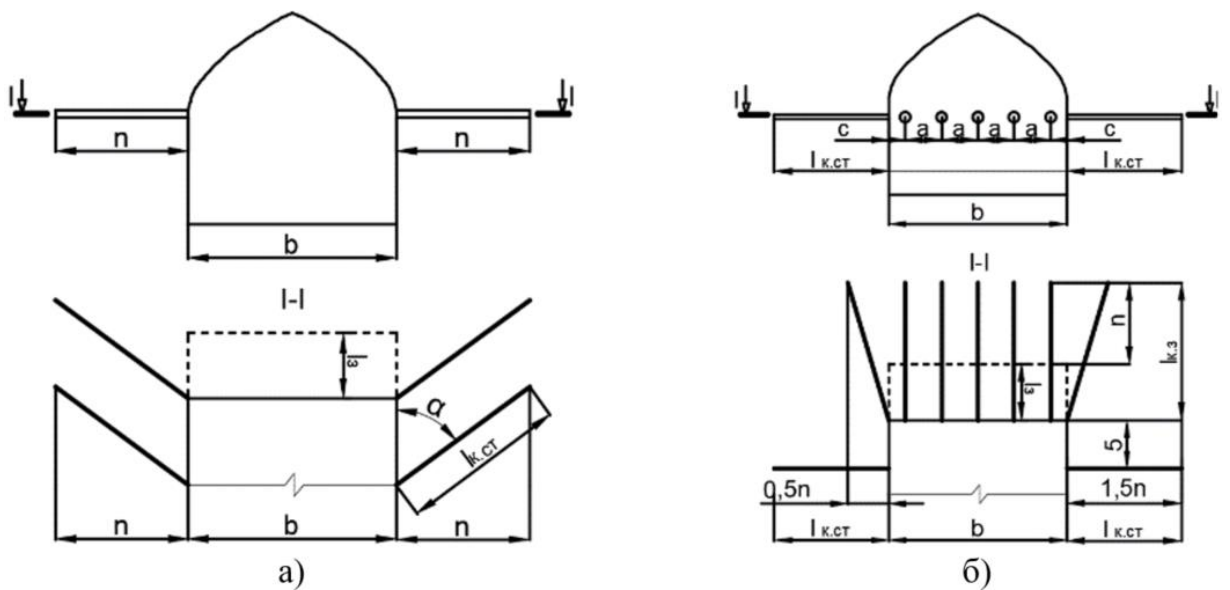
Камуфлетное взрывание шпуров при удароопасности: а) в стенках выработки; б) в забое и стенках выработки; $l_{к.ст.}$ – длина камуфлетных шпуров в стенках [37]
